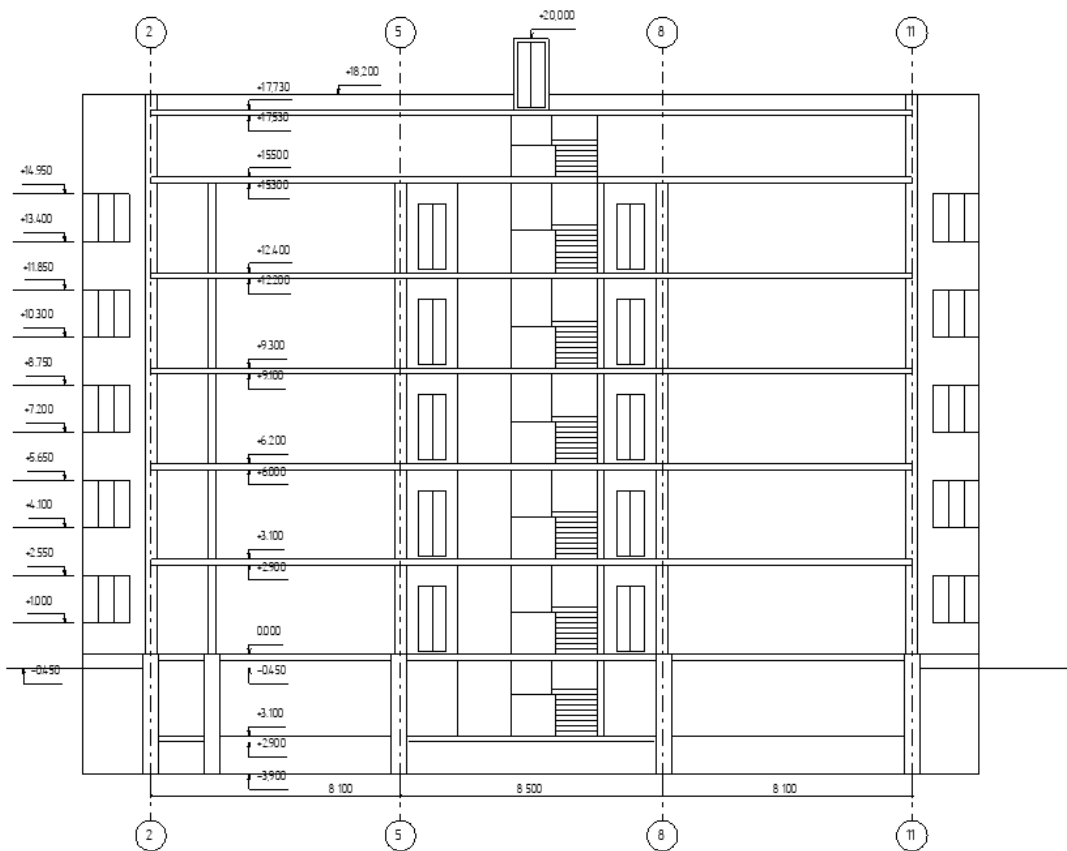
Розріз по головному фасаді будівлі 1 – го типу
